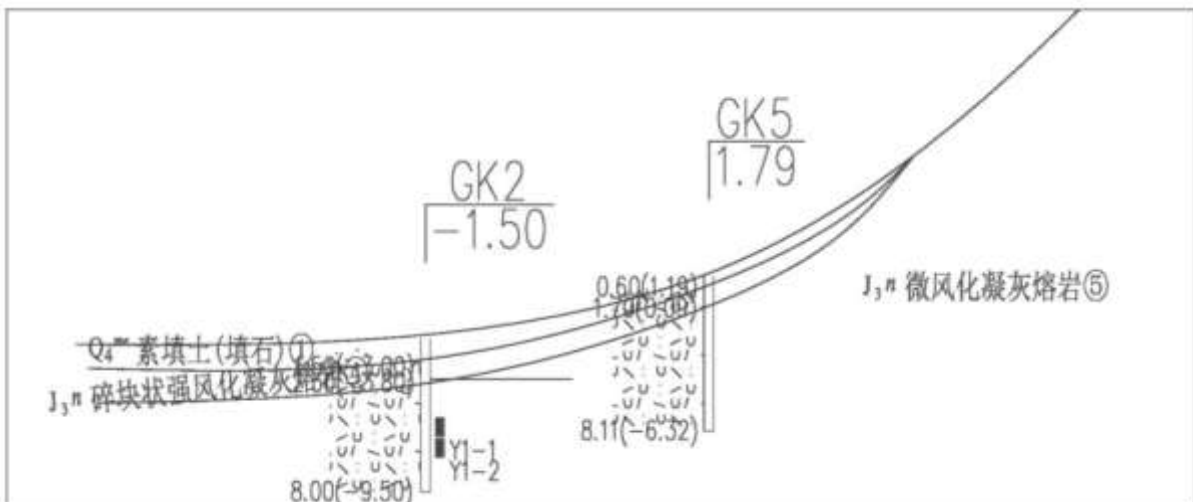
松皋陆岛交通码头工程地质剖面图 1
